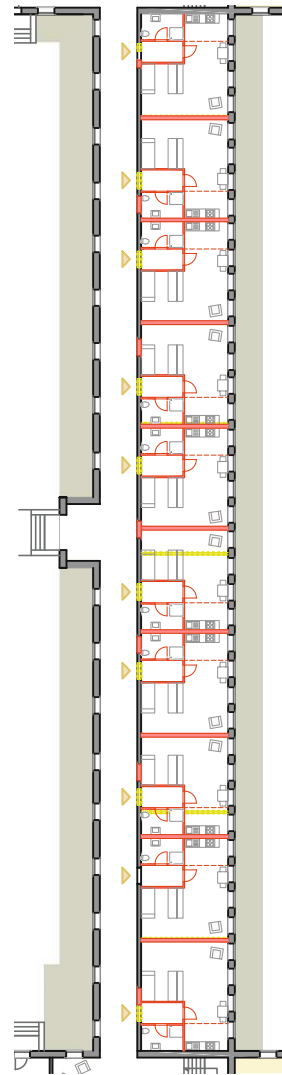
Rot-Gelb Plan Singlewohnen M 1:500
